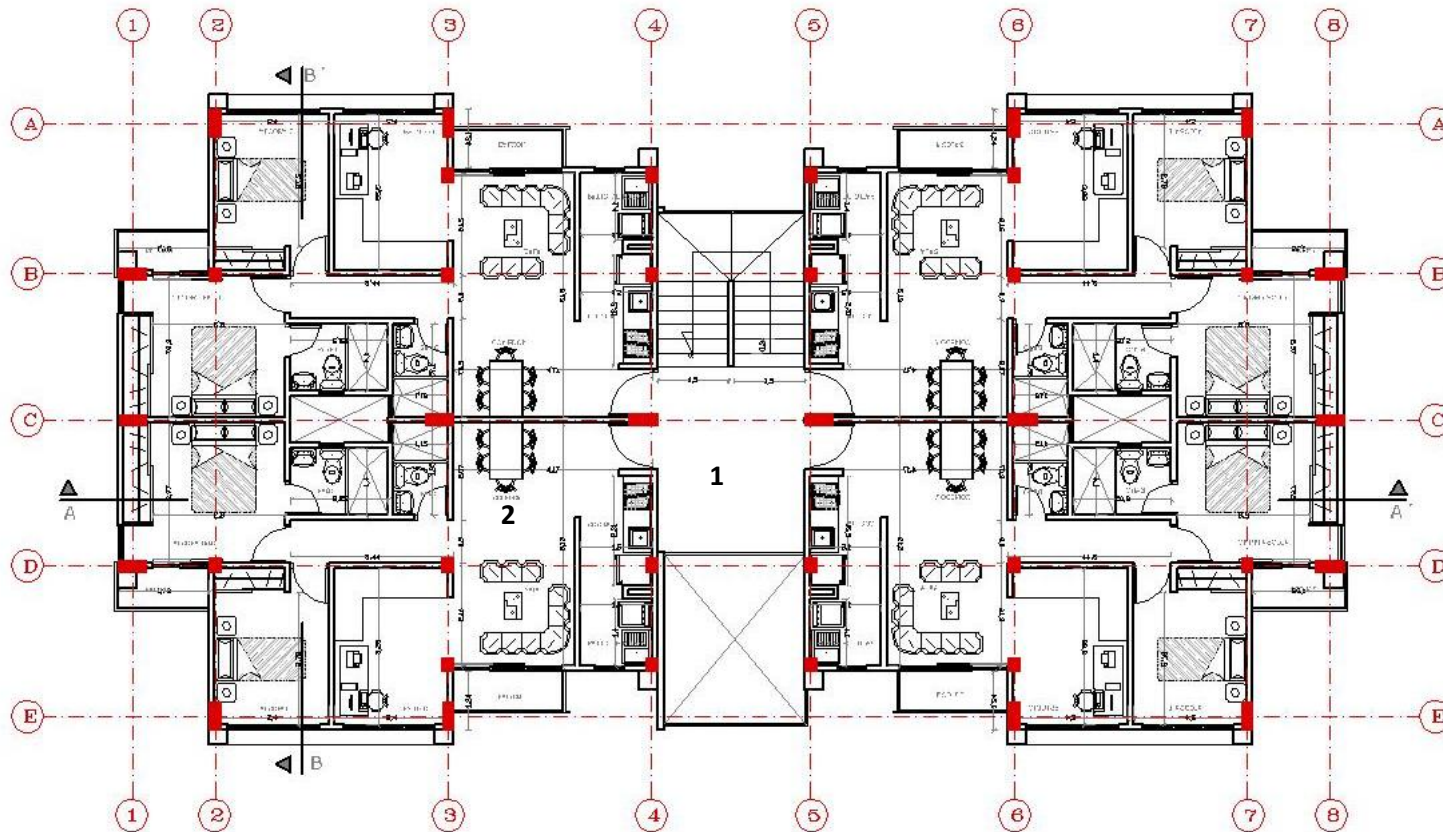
//Plano planta arquitectónica tercer y cuarto piso//
